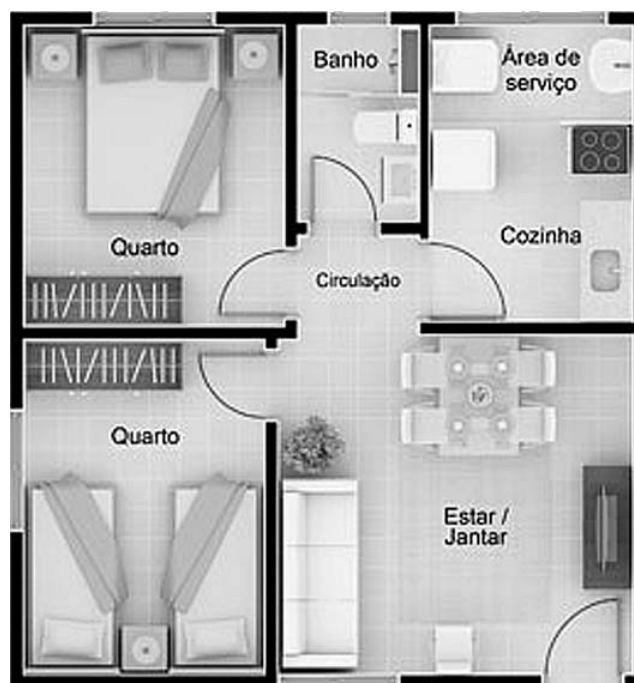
Residencial Bologna Life: Planta do Apartamento.
